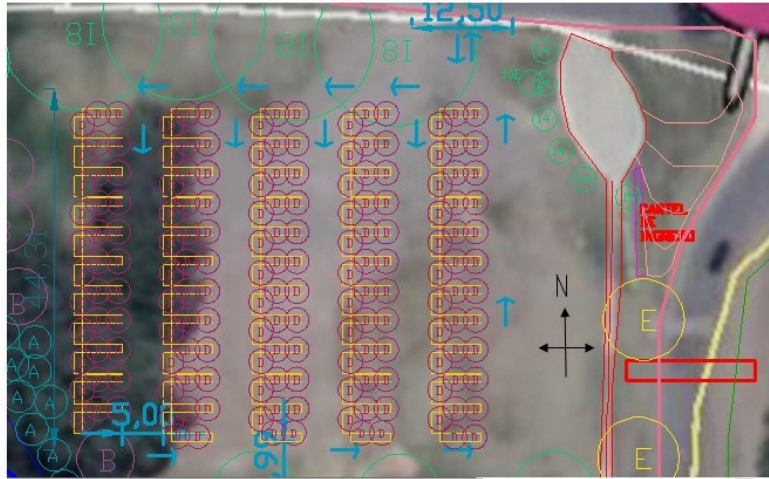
Plano del proyecto de estacionamiento. Autoría propia.
